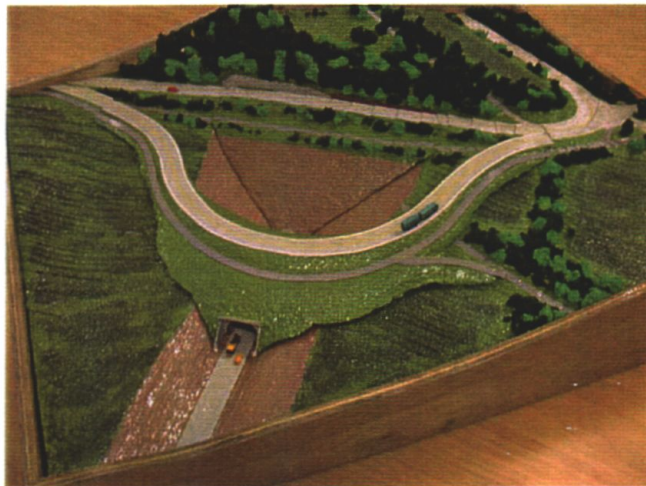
Desember 2002 skal midlertidig E6-sløyfe være etablert over betongtunnelen.
